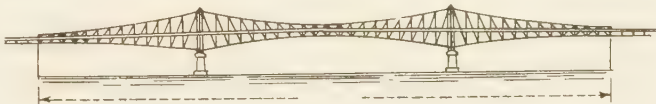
Pont de Frans, sur la Saône a Ville-franche, France.
